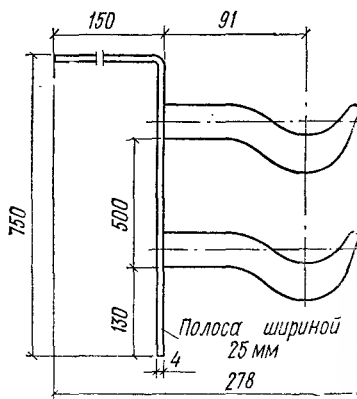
Кронштейн двойной типа 11кс (масса 0,94 кг) для крепления радиаторов на бетонных подоконниках дюбель-гвоздями
